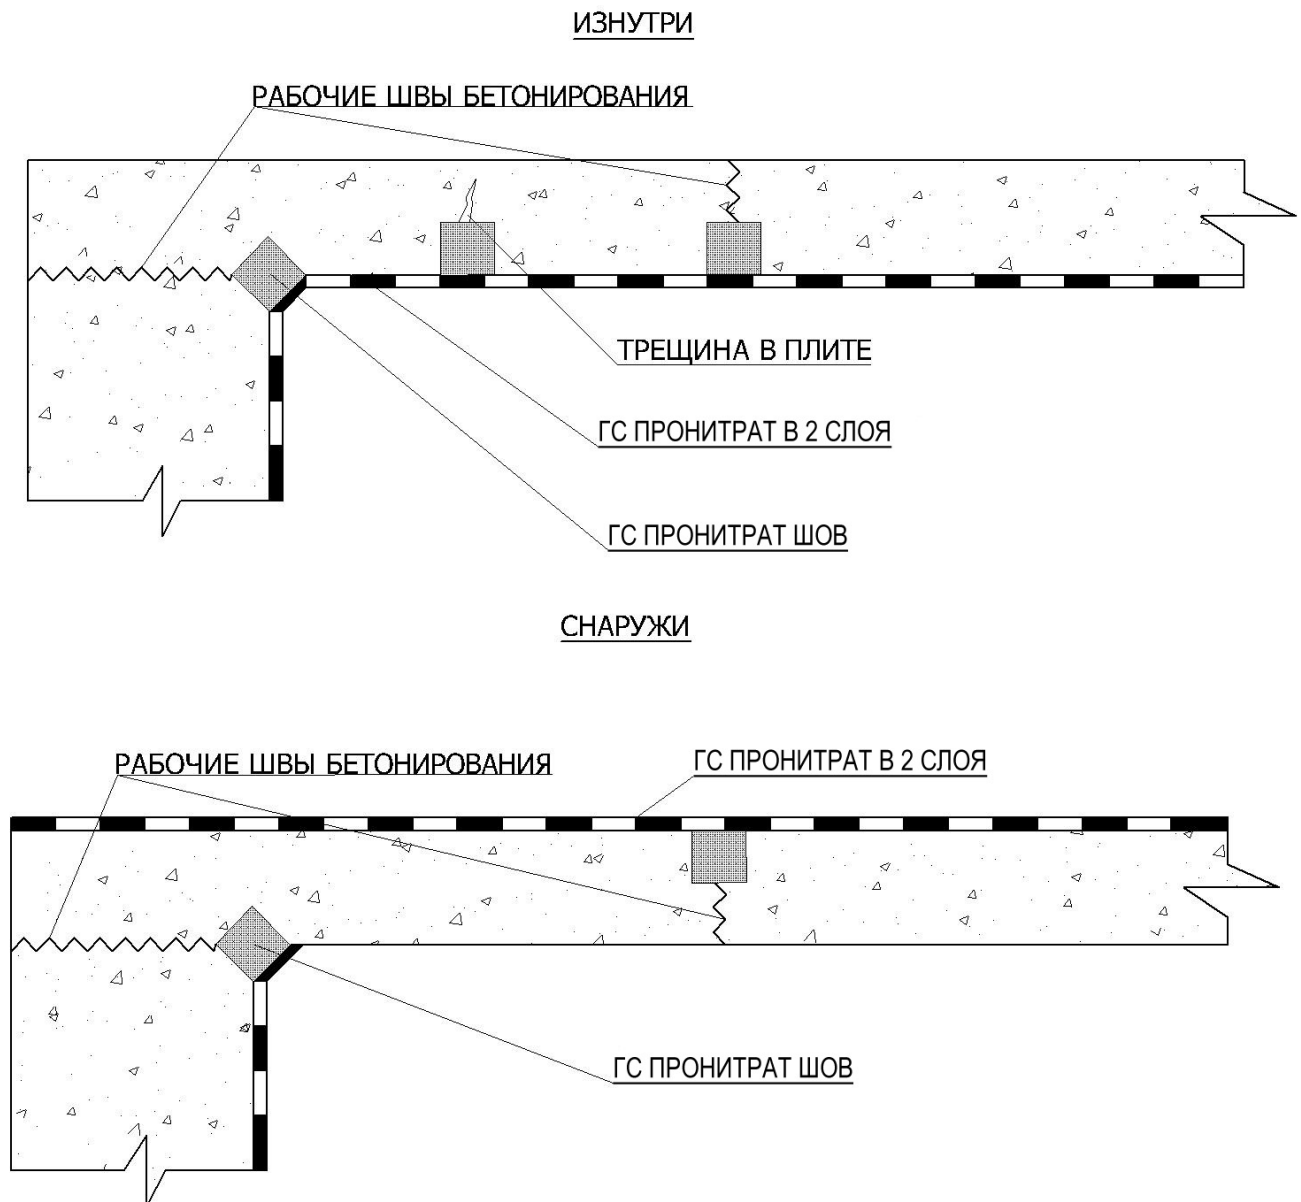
Устройство гидроизоляции монолитных перекрытий
